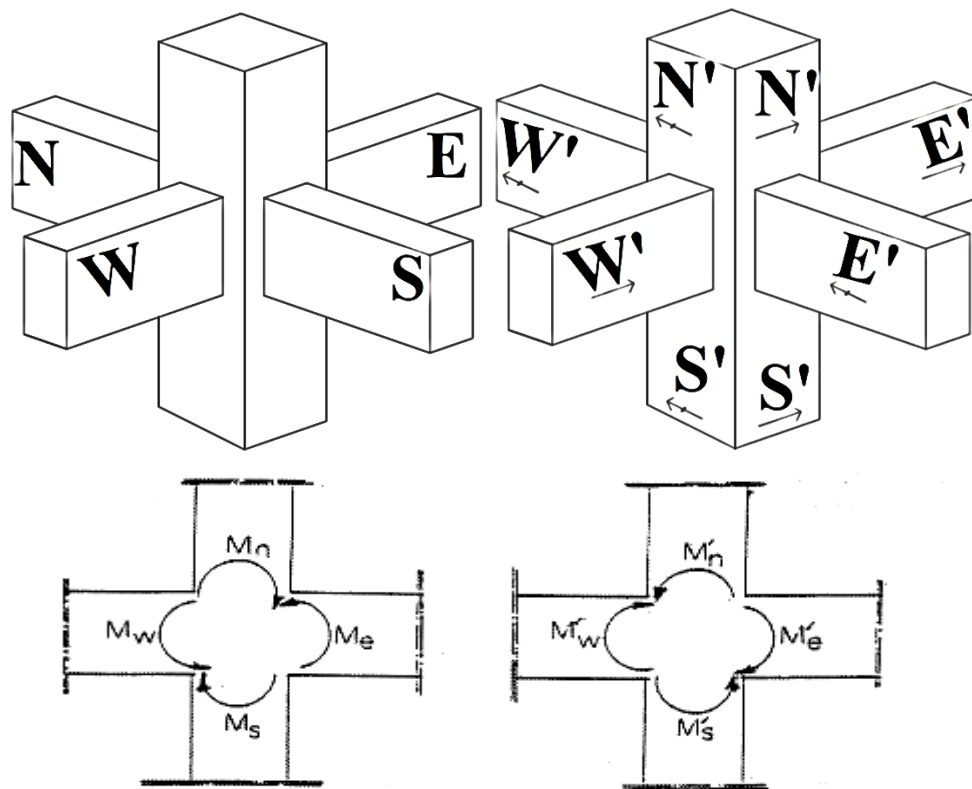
11: Dimensionnement des nœuds poteaux-poutres
